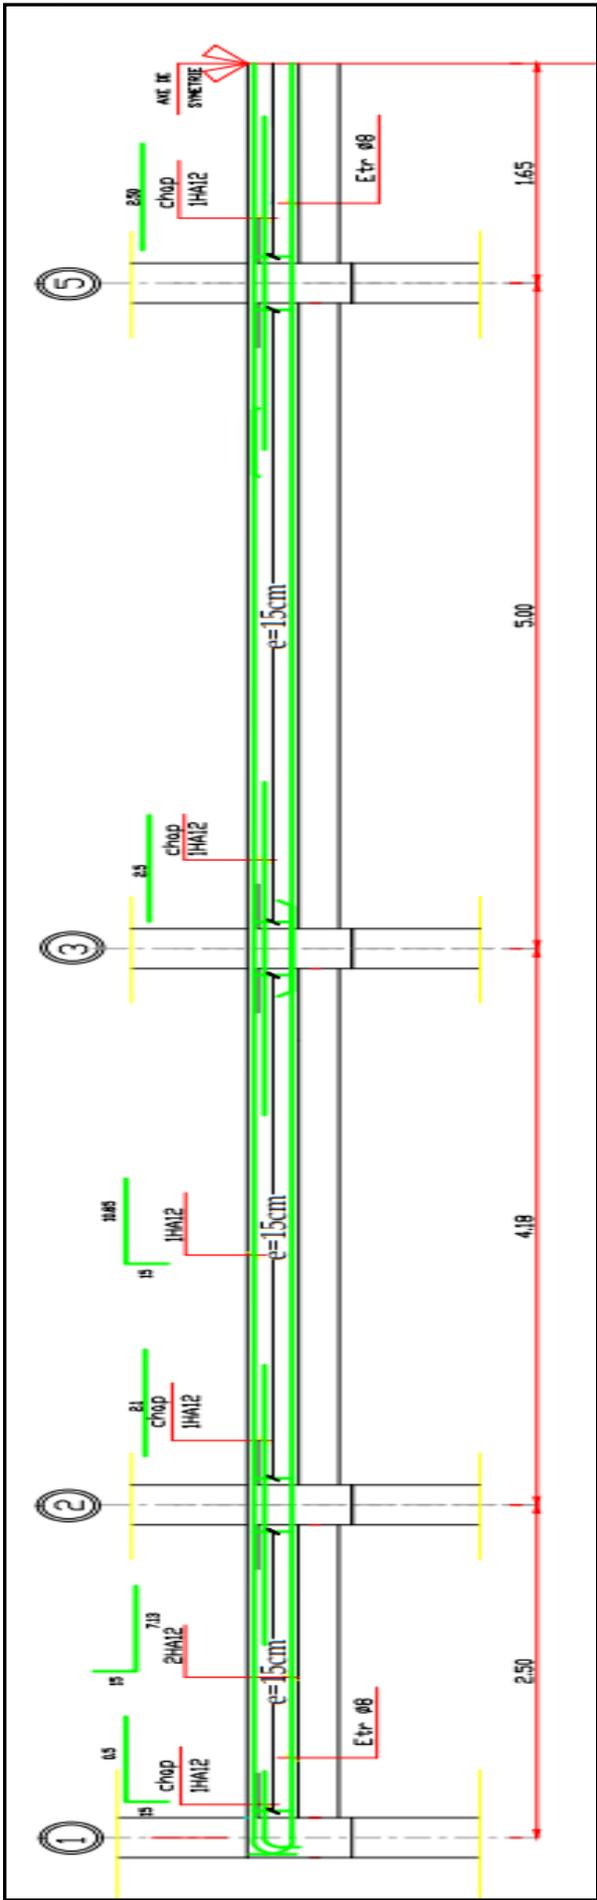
ferrailage des poutrelles intermédiaires.
